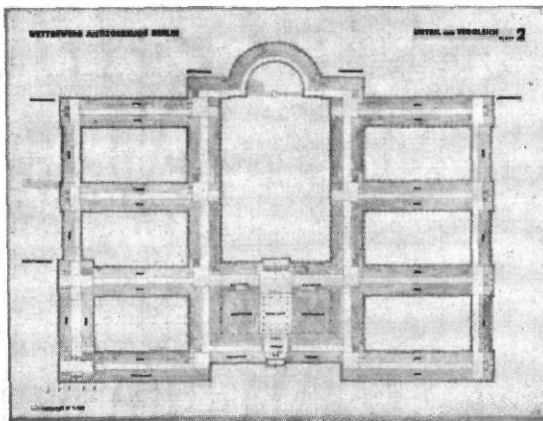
und 30 / Wettbewerb Justizgebäude Berlin / Architekt: Edgar Wedepohl, Berlin; Mitarbeiter: F. Mellin, Berlin / Grundriß 1:4000 und Lageplan 1:10000
